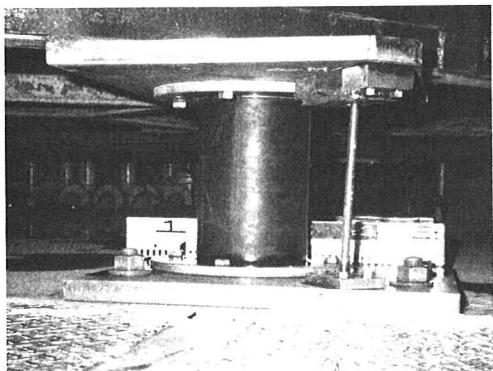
免震装置（積層ゴム+鋼棒ダンパー）
